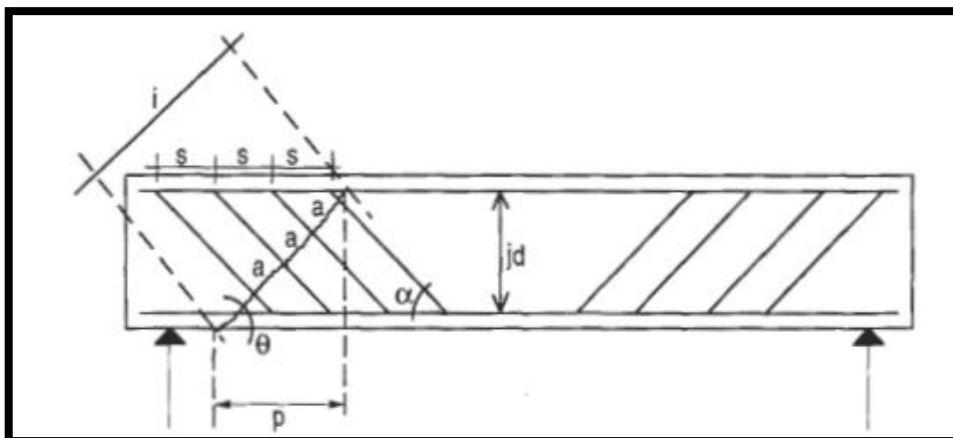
Viga sometida a tensión diagonal. Morales (2006).
